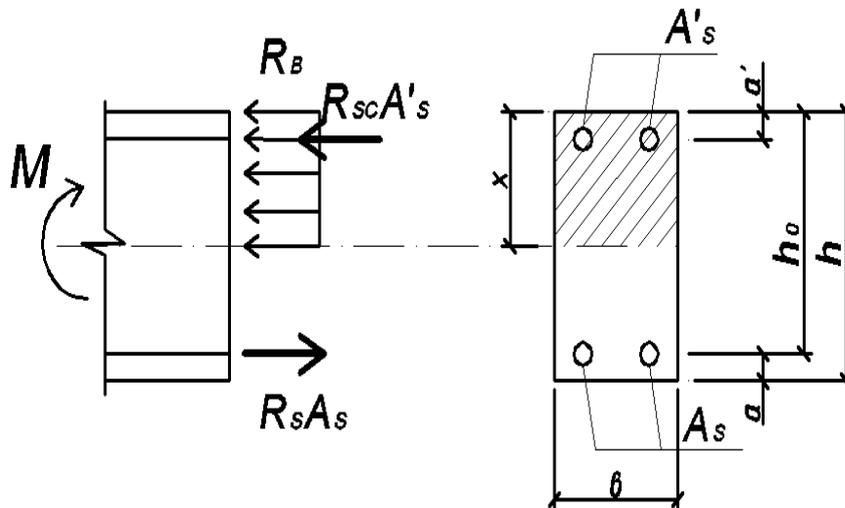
Балка прямоугольного сечения с двойным армированием:
